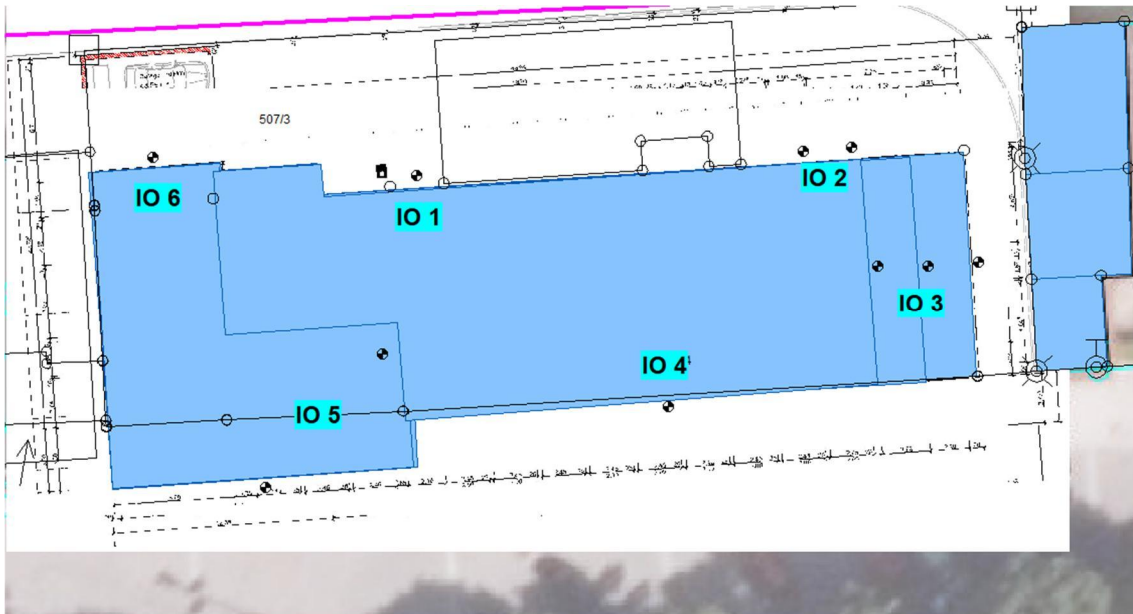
Lage der Immissionsorte am Plangebäude
